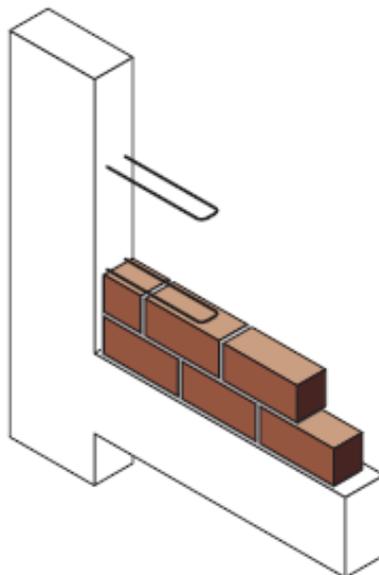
Ligação entre alvenaria e pilar com gancho de aço de dois ramos.
